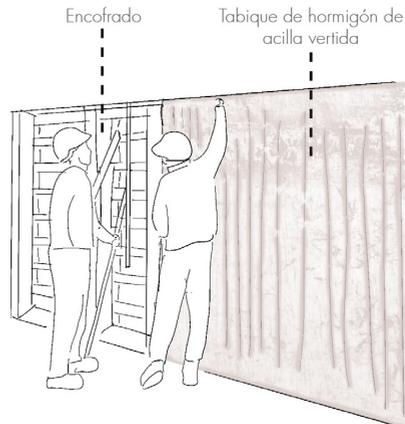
| Tabique de hormigón de arcilla siendo desencofrado. | Fuente: Autoría Propia(2024).
